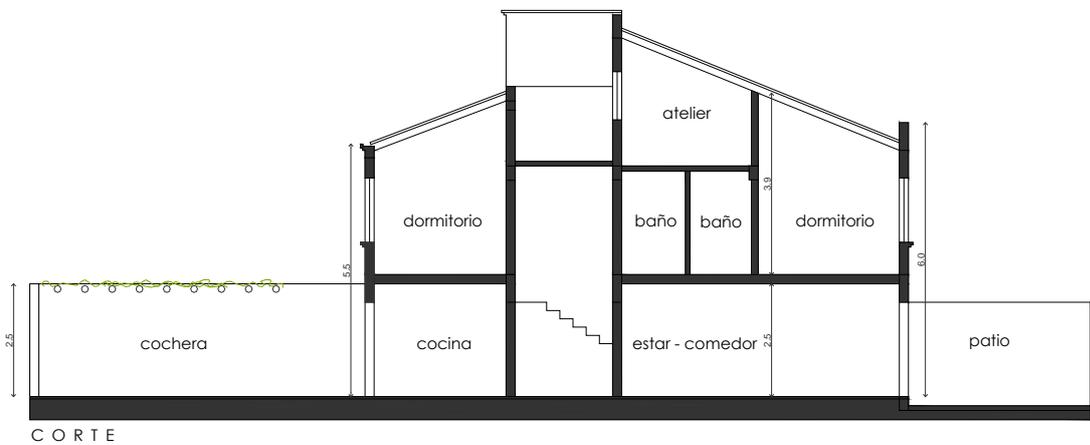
Corte de la vivienda. Fuente: Planos municipales conforme a obra.
